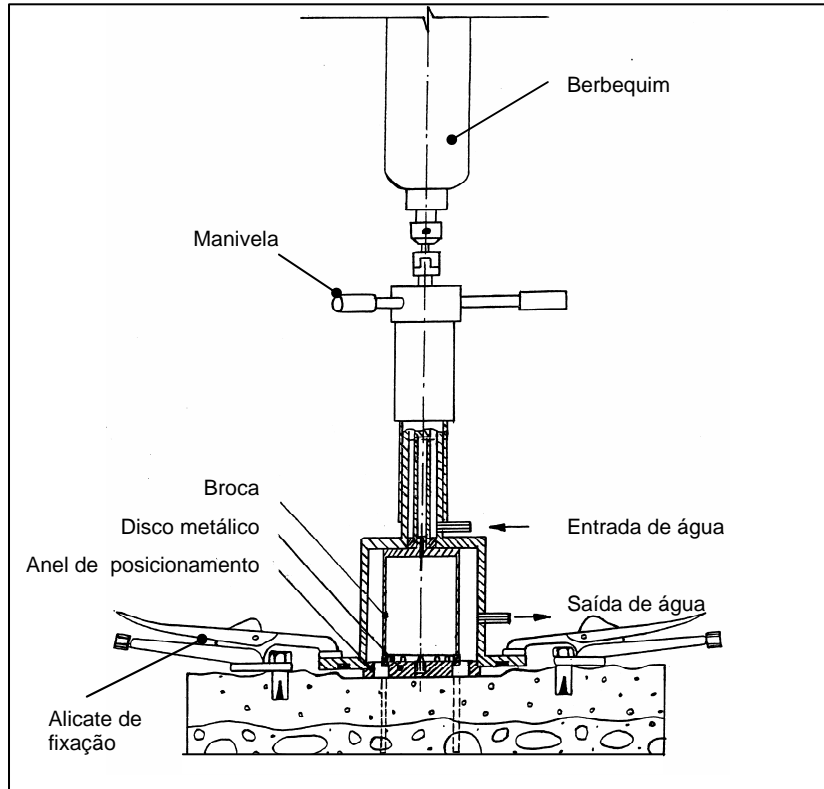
Fixação do equipamento de carotagem em superfícies irregulares [45]
